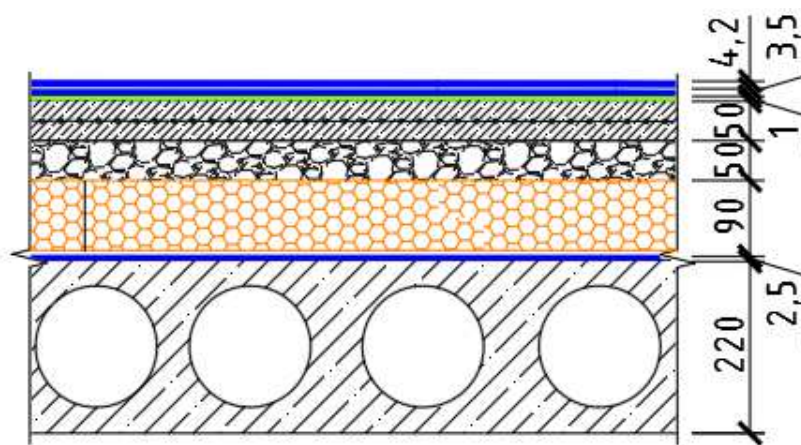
Схема ограждающей конструкции перекрытия кровли
